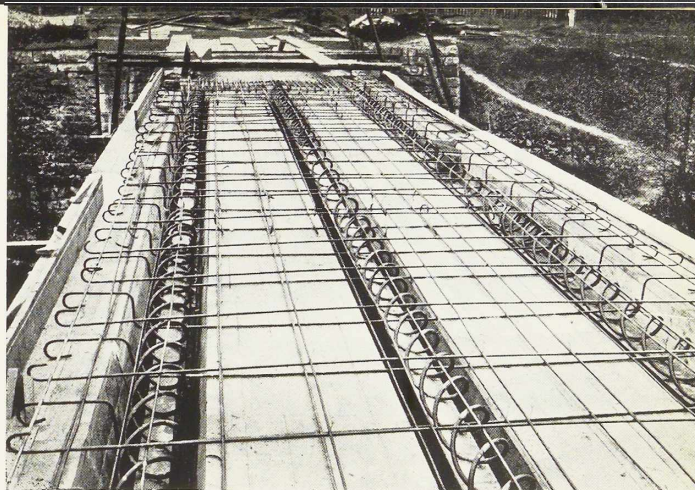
Renforcement du pont en arc sur la Birse à Laufon, comportant 2 travées de 14 m, à poutres I PN 32.
